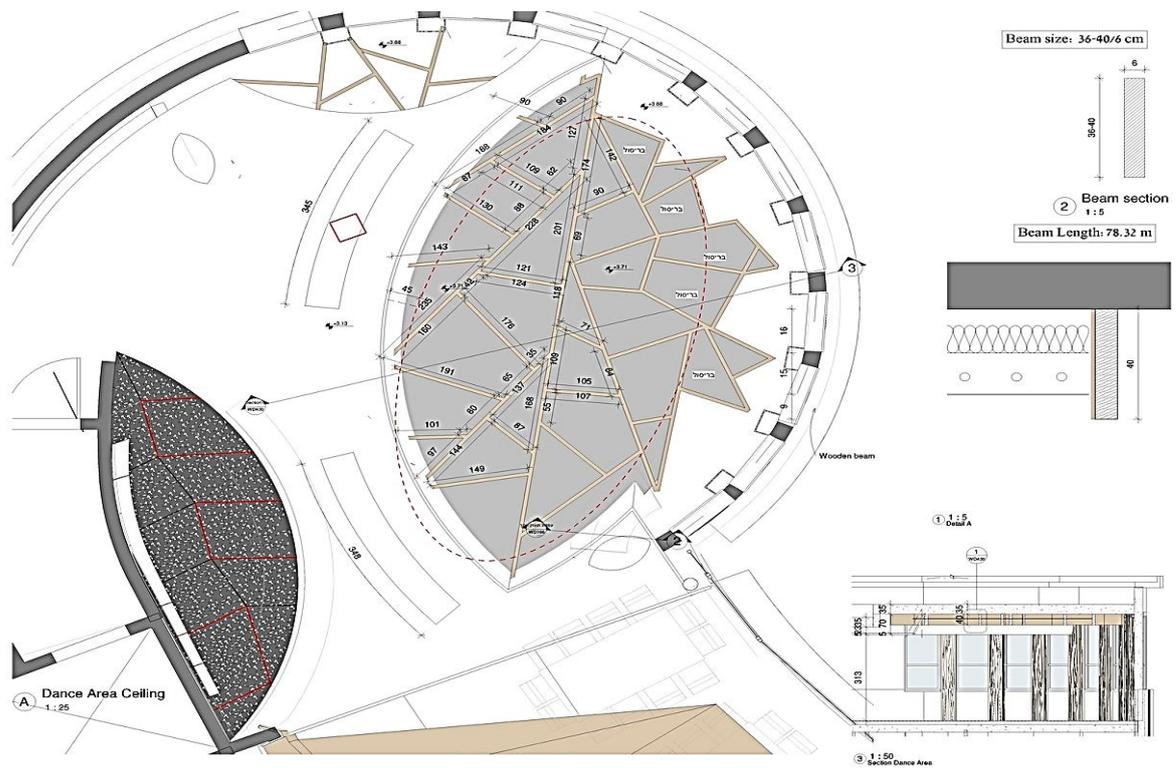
Planta de Cobertura e detalhamento de algumas estruturas
